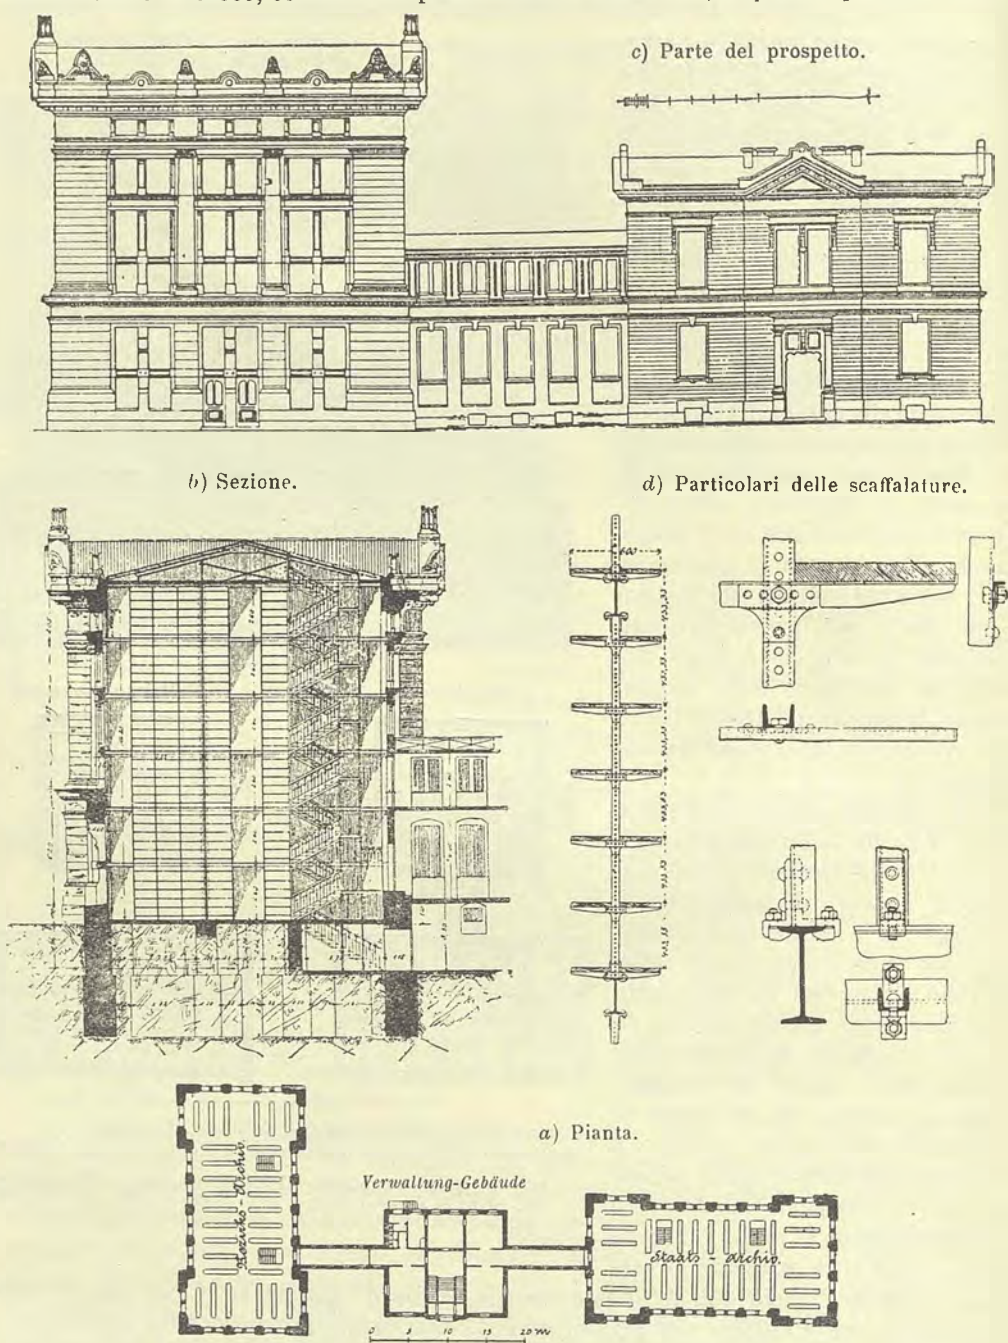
a, b, c, d. — Archivio Imperiale di Strasburgo (arch. Metzenthin).
